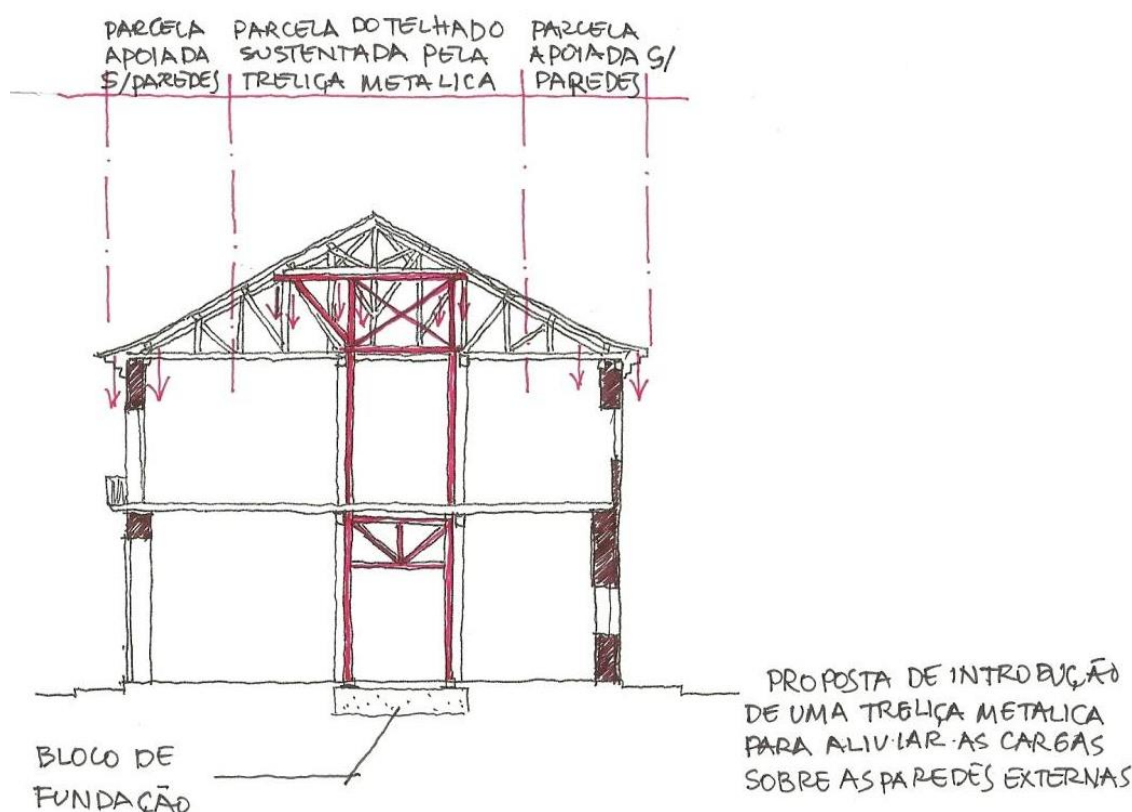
Proposta de introdução de estrutura metálica. Fonte: Desenho M. Carrilho.
